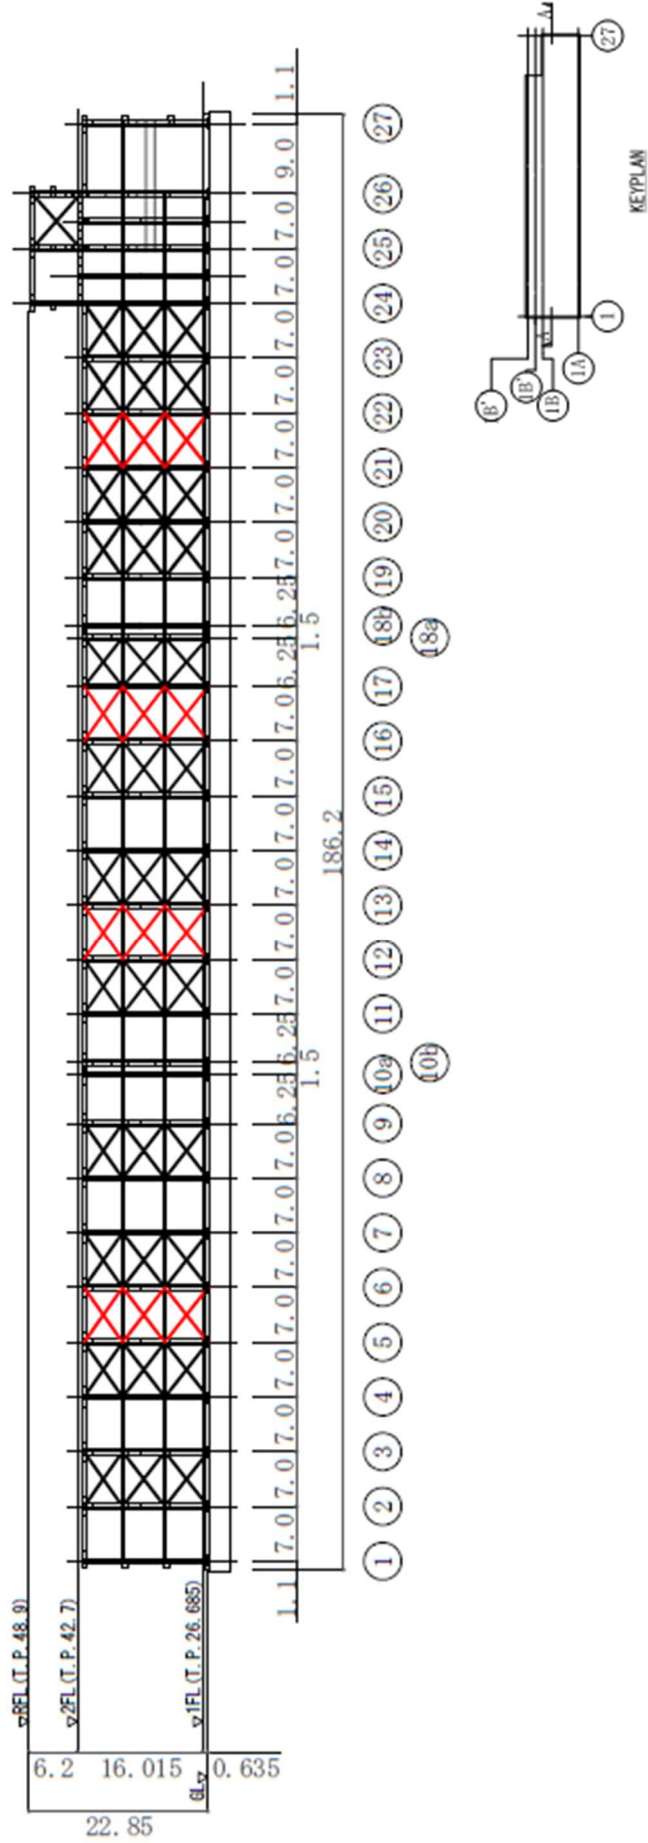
(5) A-A 断面图 (NS 方向) (单位 : m)
